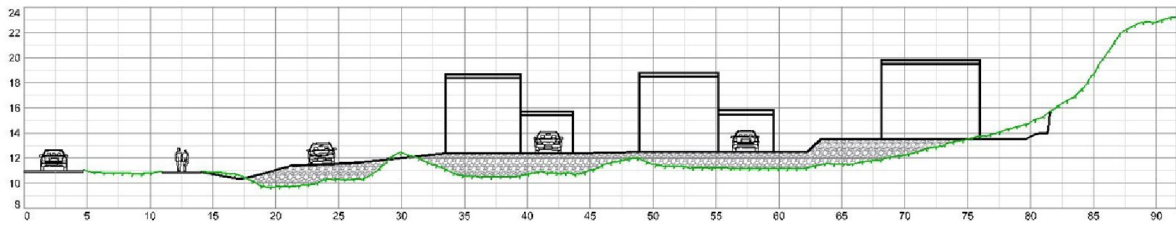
Plan skisse, av mulighetsvurdering Sundvegen boliger.
